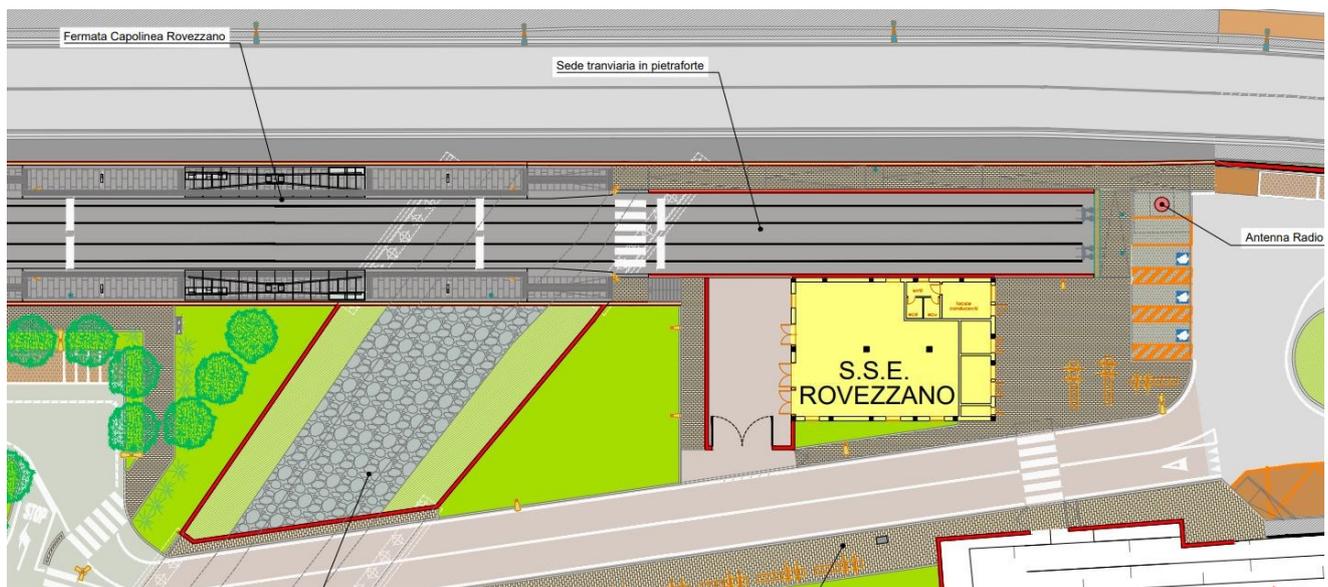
Planimetria di progetto dell'area del capolinea di Rovezzano
